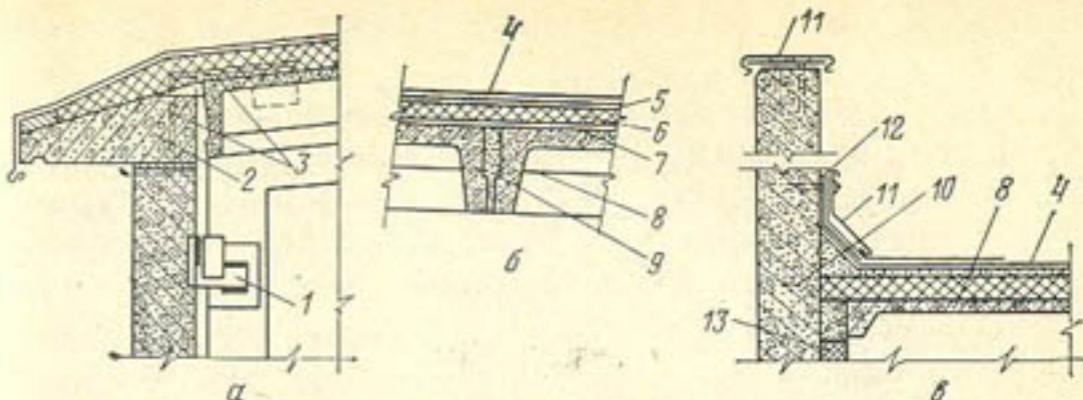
Конструкция отдельных элементов покрытий промышленных зданий:
